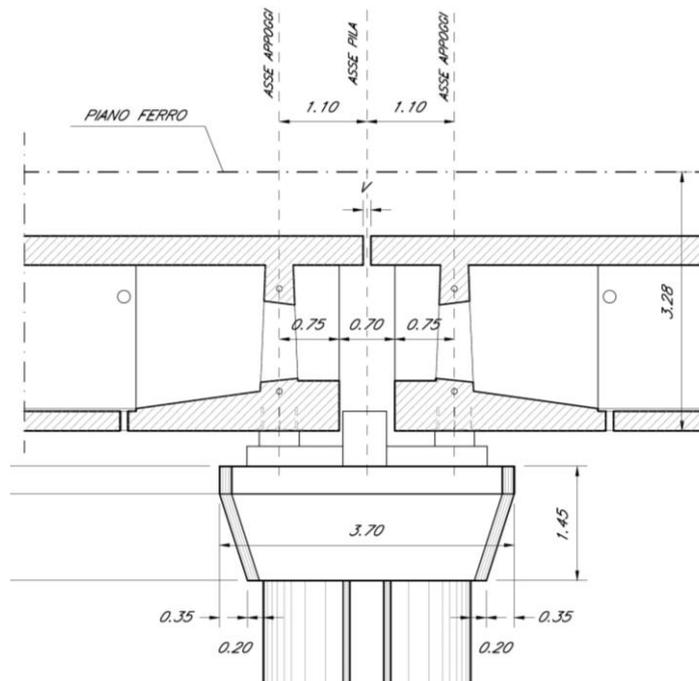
Pila, prospetto longitudinale – Due impalcati CAP
